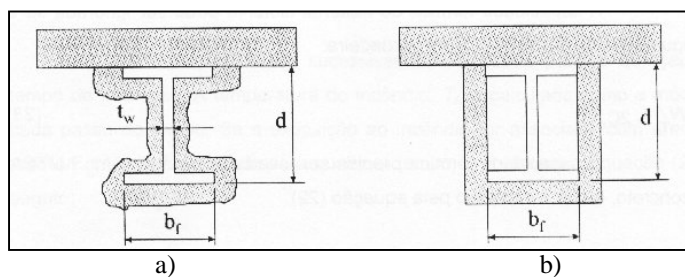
Proteção tipo contorno (a) e proteção tipo caixa (b), aplicados à uma viga *I* sobreposta por laje de concreto.
